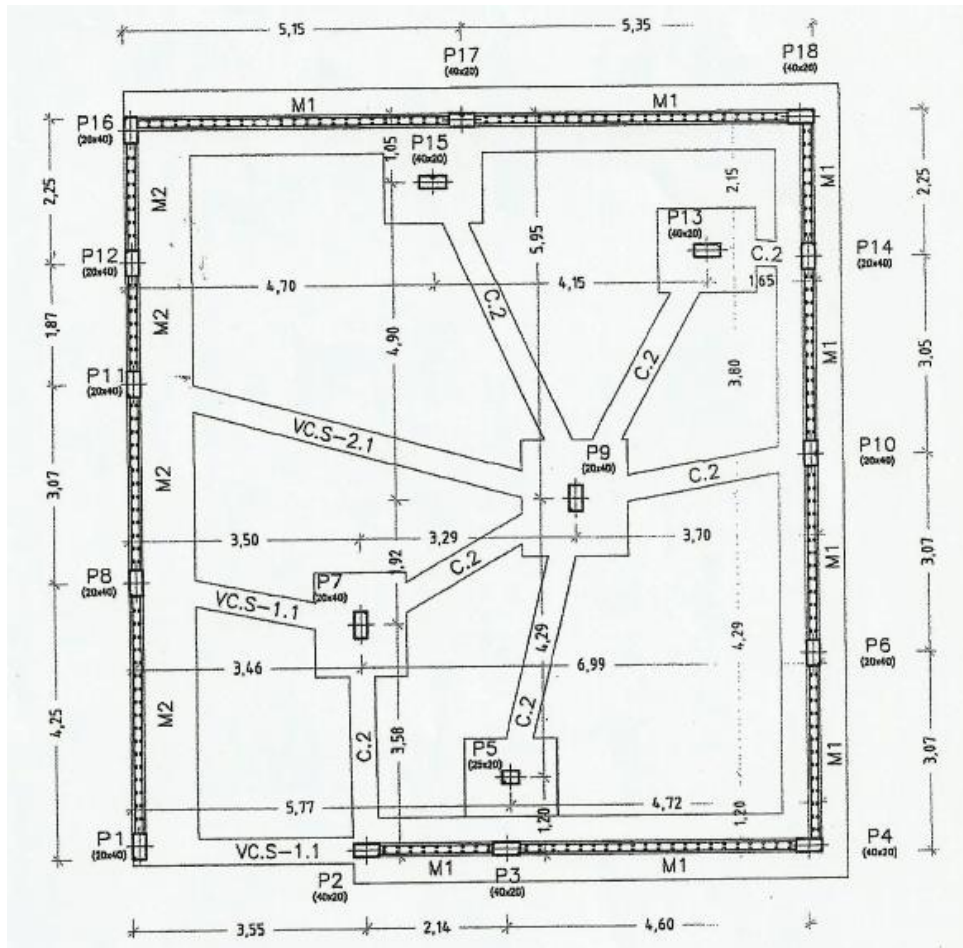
Projeto de Estabilidade – Planta de Fundações
